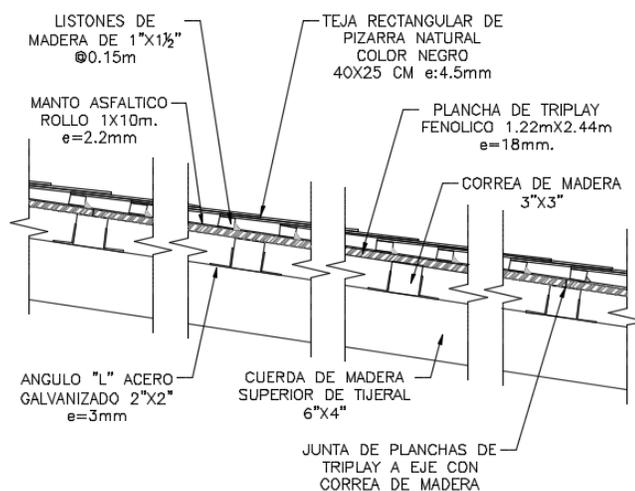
Detalle de techo de tijerales y teja pizarra. Fuente: Elaboración propia.
